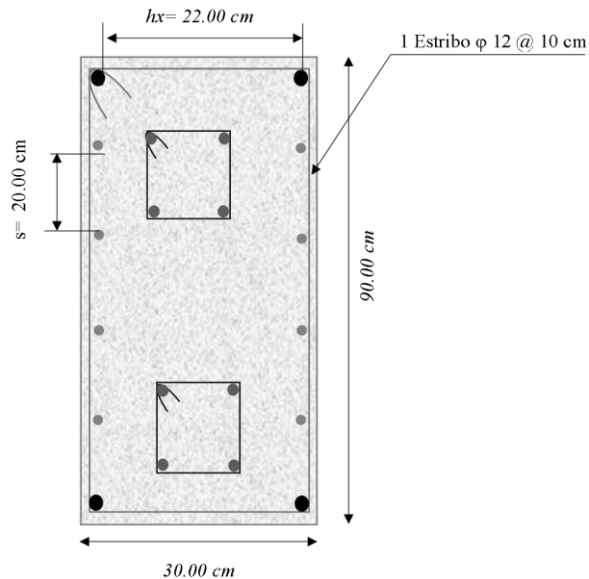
Armado de las vigas de acople de la geometría 2 y 3 en base al DDBD
